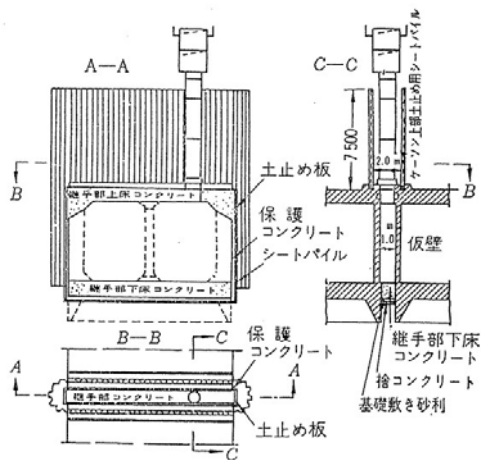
ケーソン間継手部施工図⁴⁾
